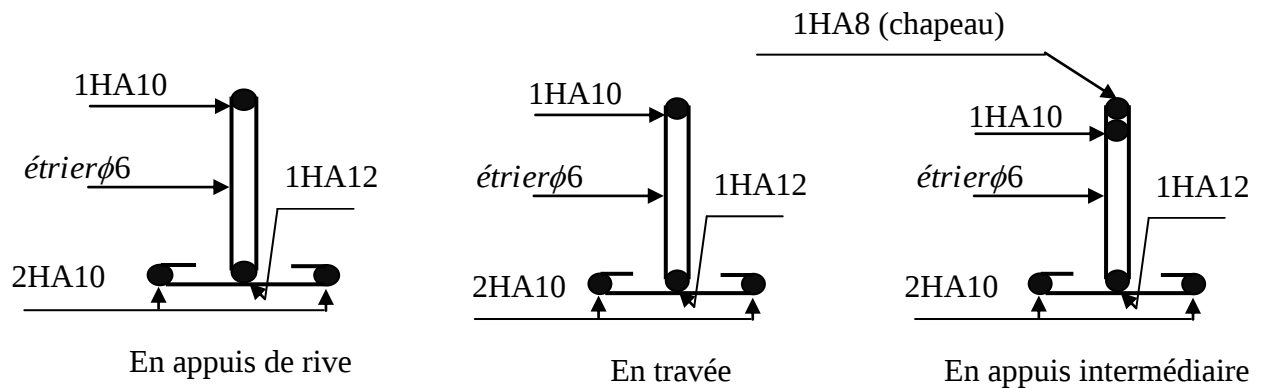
Schémas de ferrailage de la poutrelle type 04 de l'étage courant.
